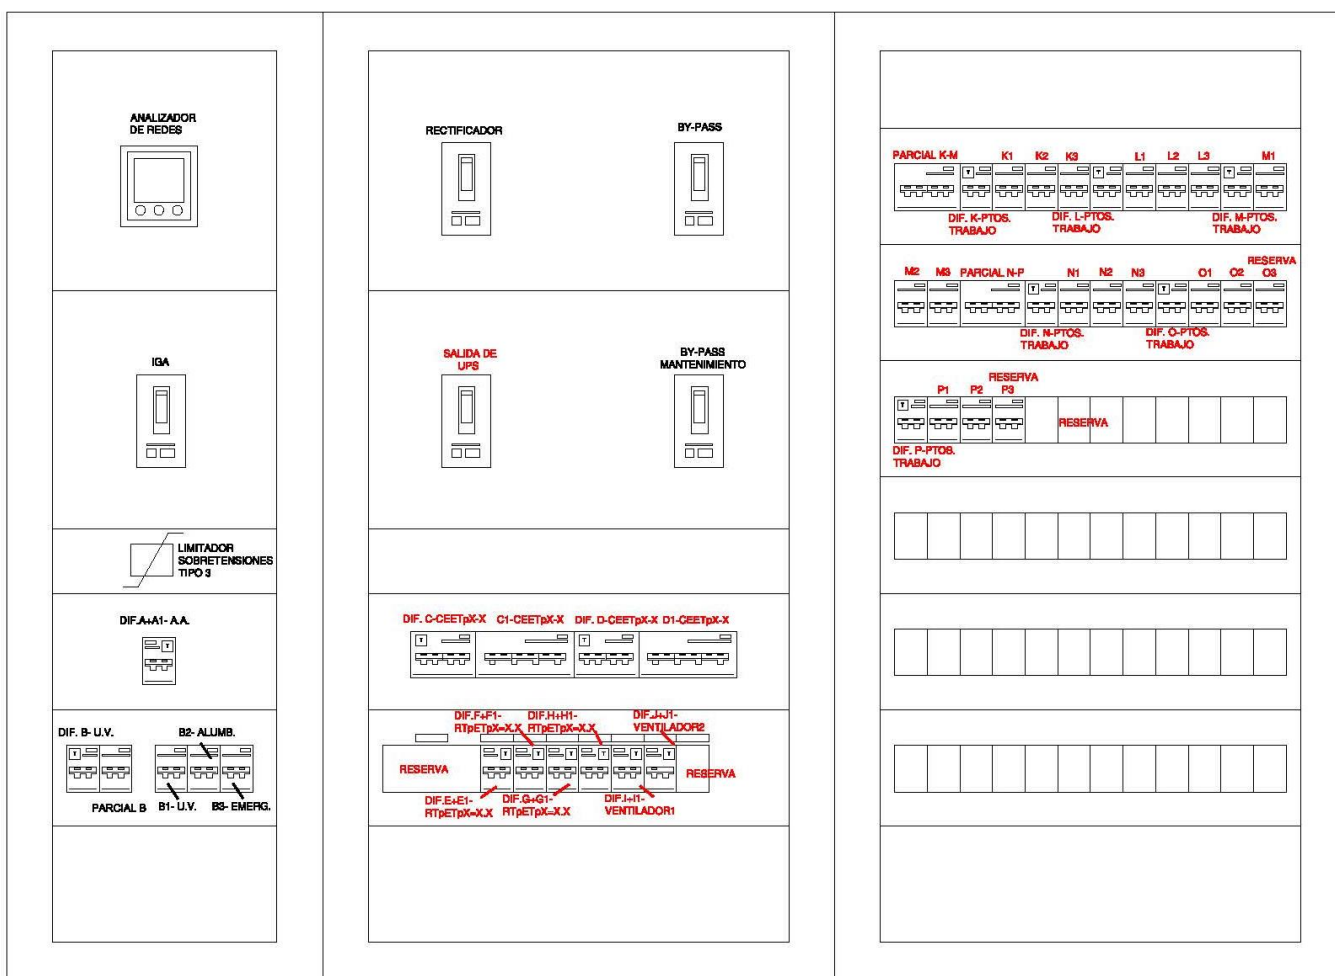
Esquema Unifilar Tipo Cuadro Eléctrico Secundario de planta
